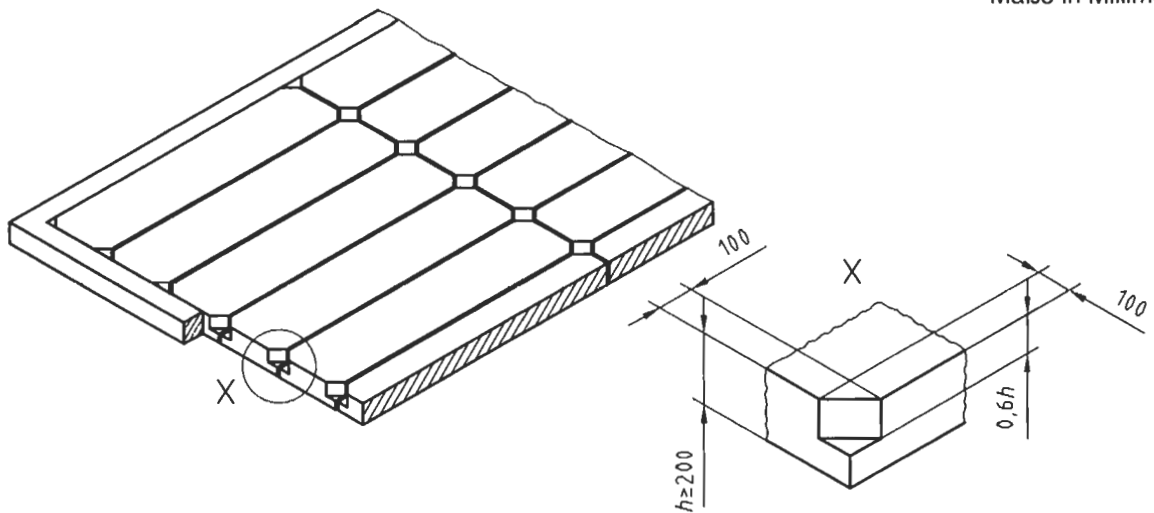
Ausbildung einer Scheibe mit Fugenbewehrung, Betoneckdübeln und umlaufendem Stahlbetonringanker
